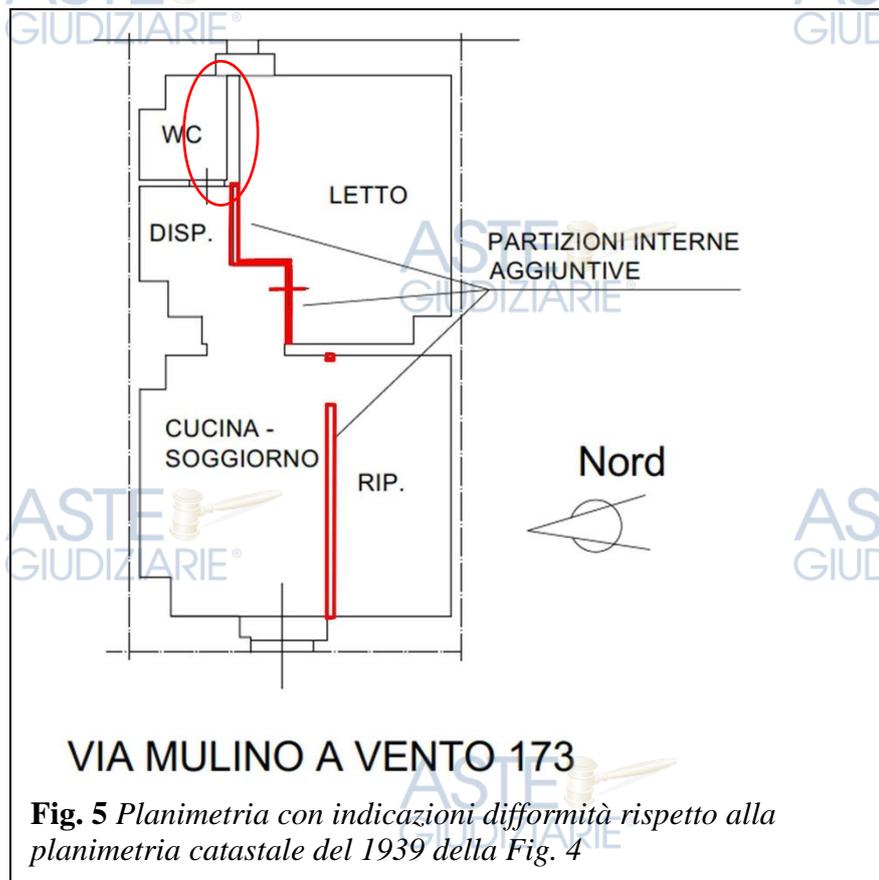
Planimetria con indicazioni difformità rispetto alla planimetria catastale del 1939 della Fig. 4
